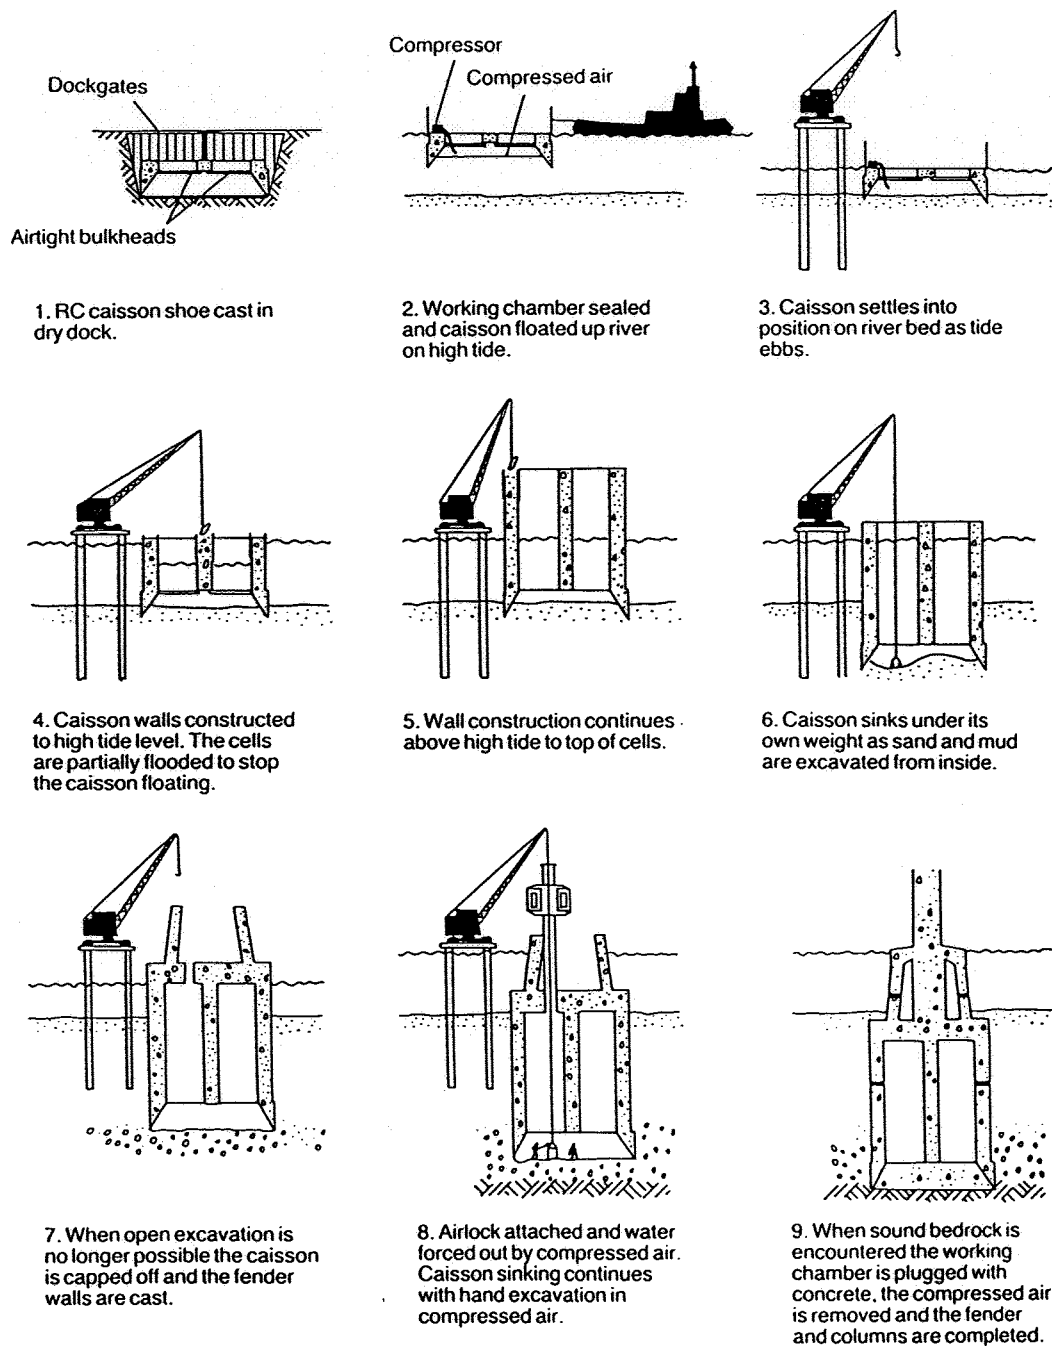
Fases de construcción e hinca de los cajones empleados como cimentación de las pilas principales de un puente sobre el río Torridge (Inglaterra).
